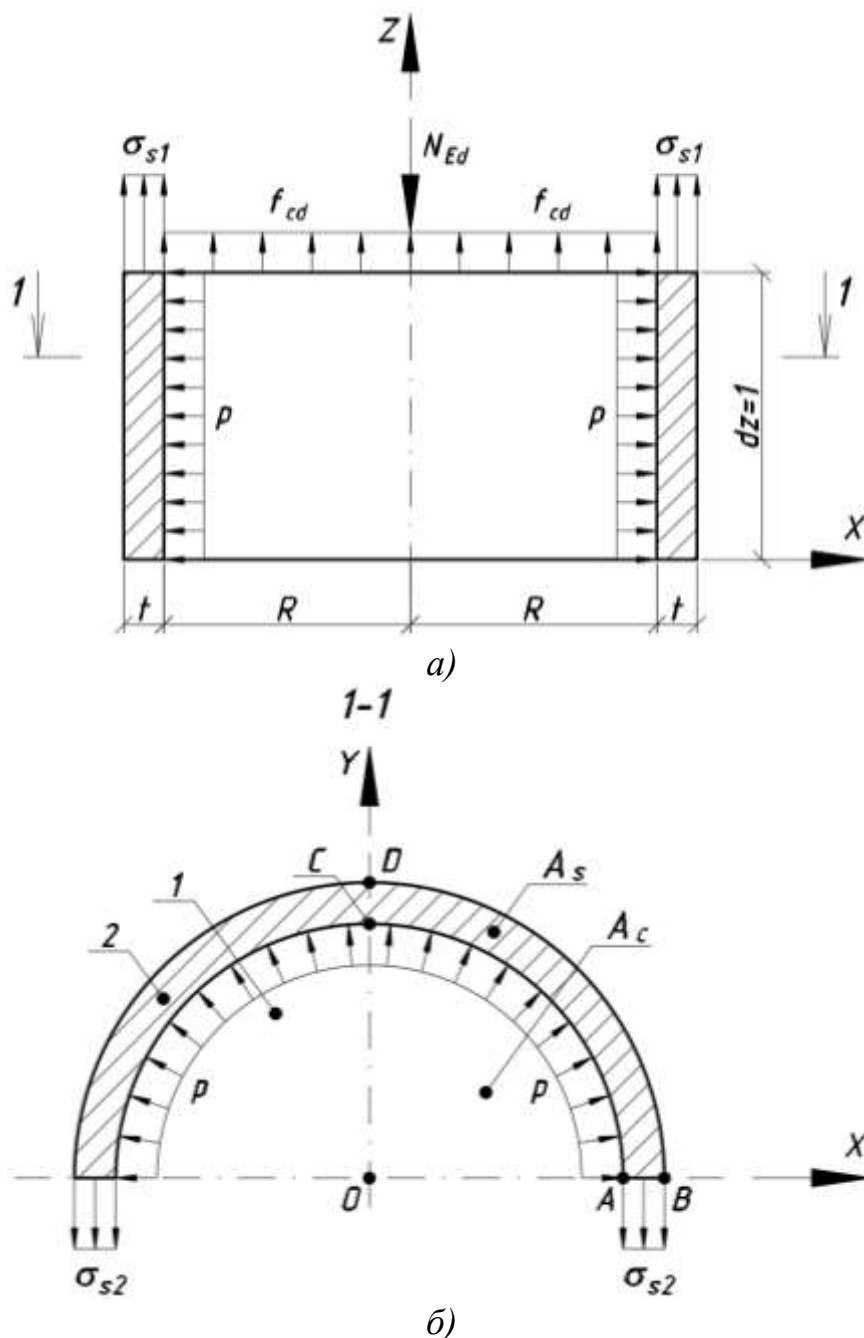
Розрахункова схема напруженого стану трубобетонної колони круглого перерізу ([8], стор. 27):
